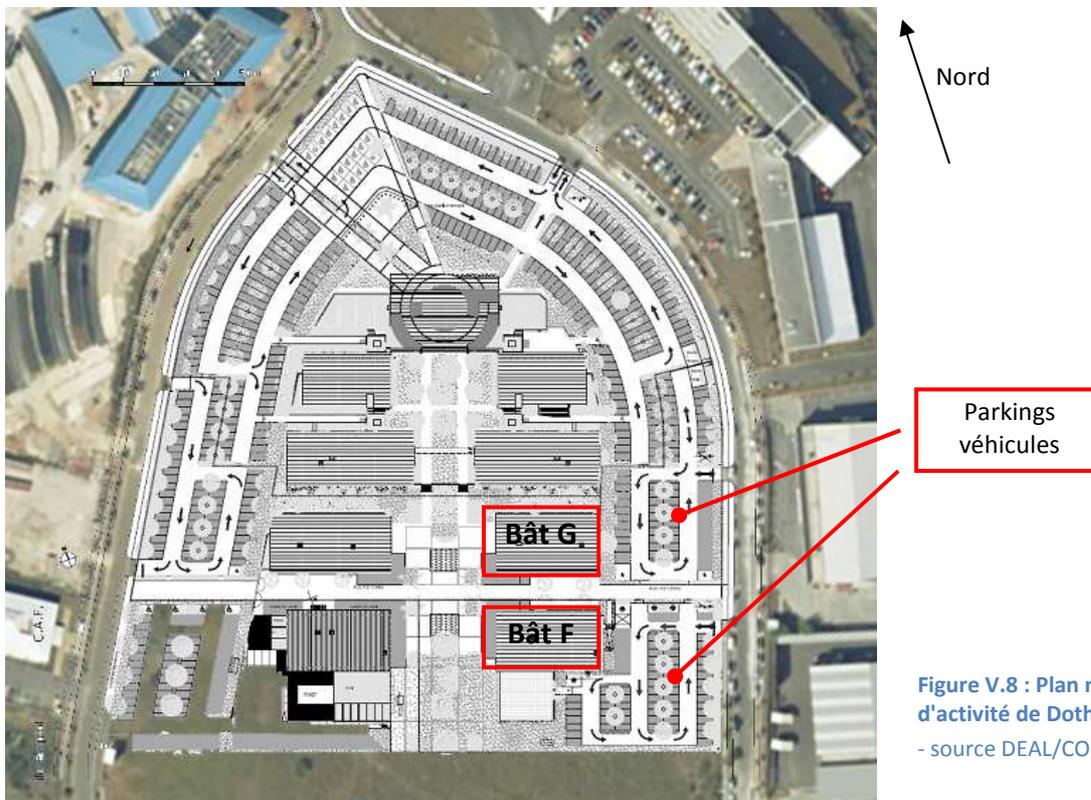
Plan masse de la zone d'activité de Dothémare
